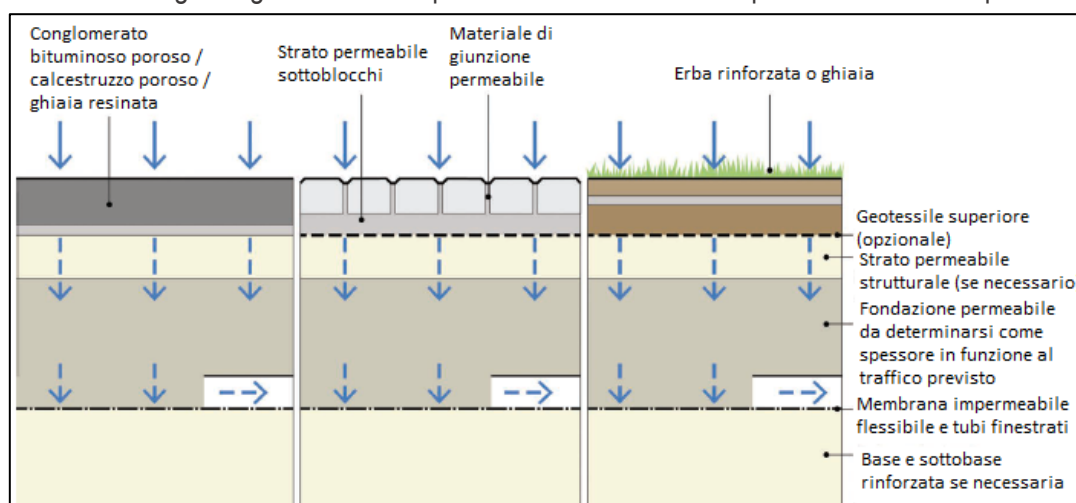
Sistema di pavimentazioni drenanti di detenzione e drenaggio. – SUDS Manual (2015).
